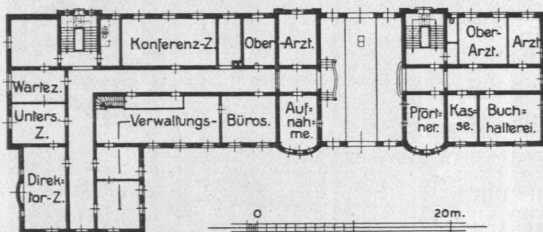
Irrenanstalt Friedrichsberg, Verwaltungsgebäude, Erdgeschoss, Grundriß.
